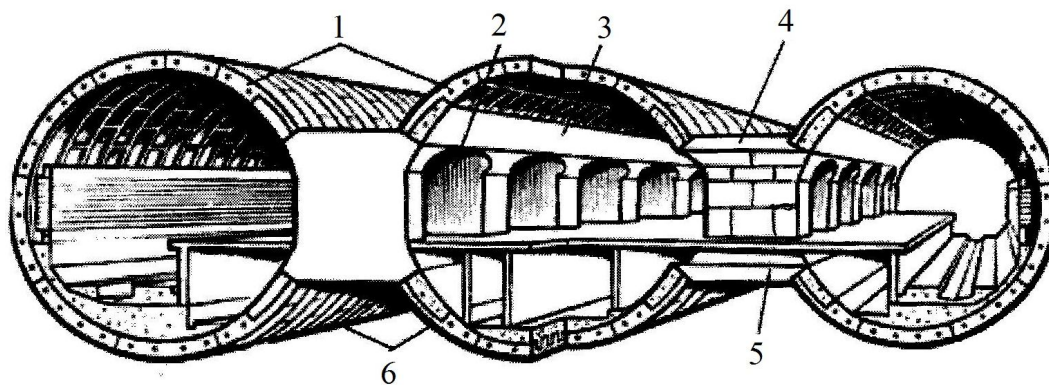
Схема пилонной станции с железобетонной обделкой и перекрытием проемов железобетонными балками: 1 – верхний фасонный тюбинг; 2 – проход из центрального зала к платформе; 3 – верхние монолитные железобетонные балки проема; 4 – бетонная обделка прохода; 5 – нижние железобетонные балки проема; 6 – нижний фасонный тюбинг
